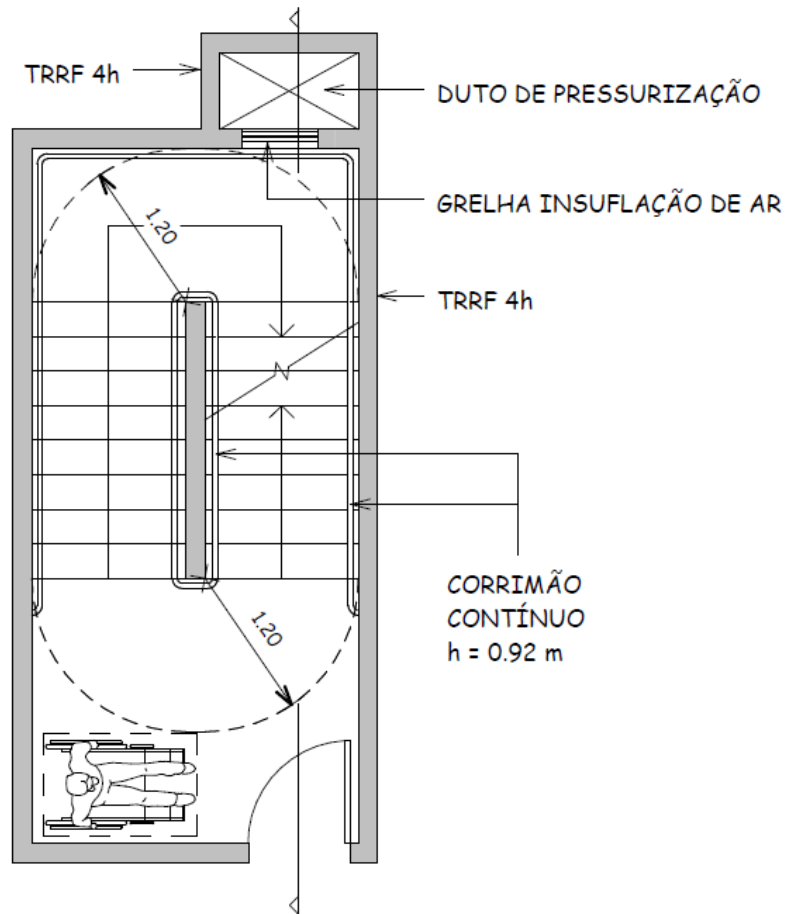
B - Escada à prova de fumaça pressurizada - pavimento intermediário (planta baixa).
